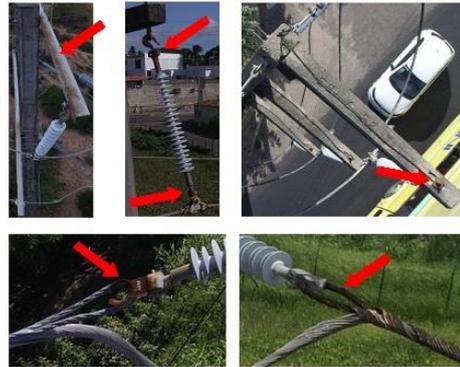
Estruturas que apresentam oxidação em suas partes
